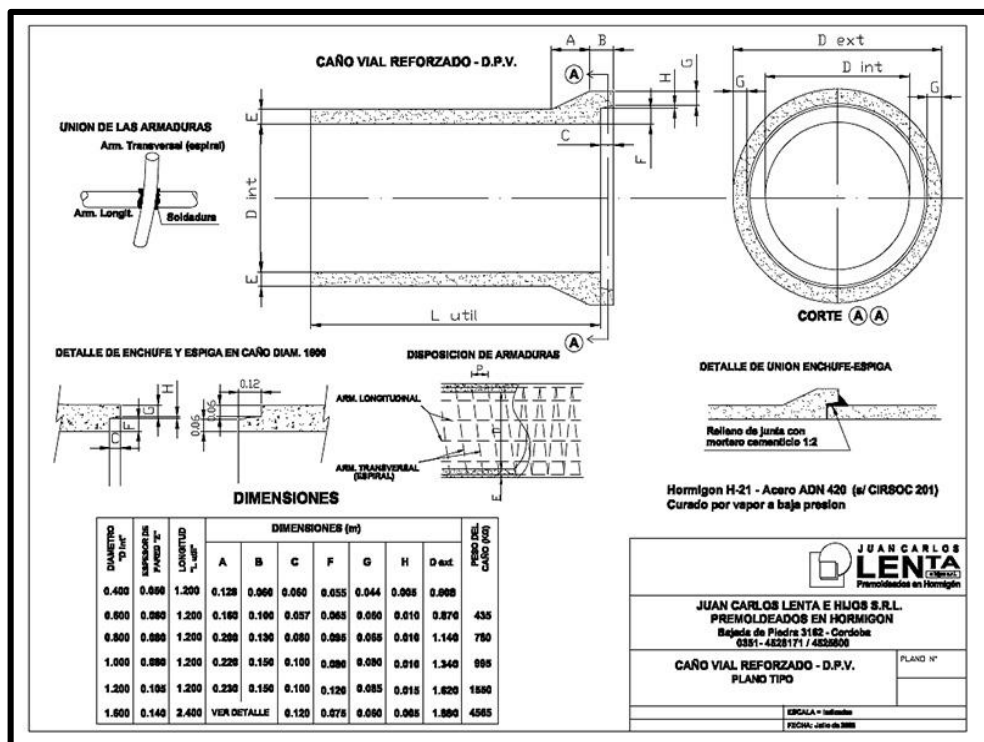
Características del tubo de alcantarilla. Fuente: JUAN CARLOS LENTA E HIJOS S.R.L
